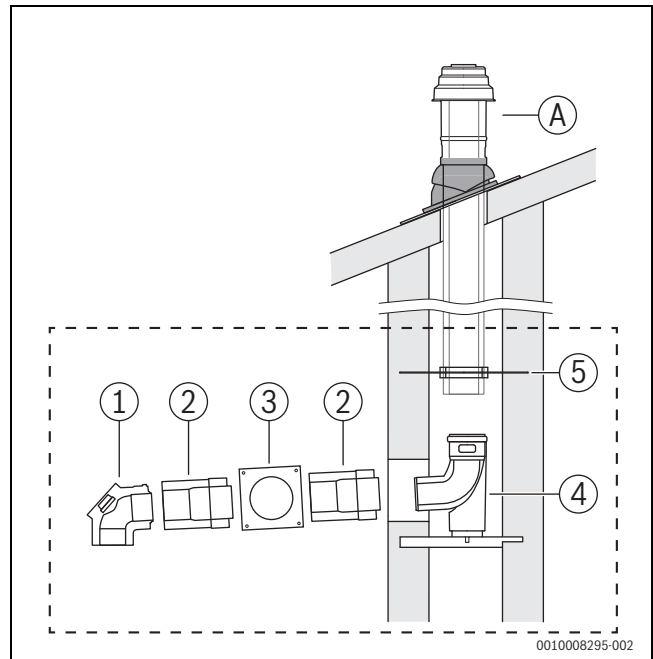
Bauteile Grundbausatz DO-S aus Kunststoff
